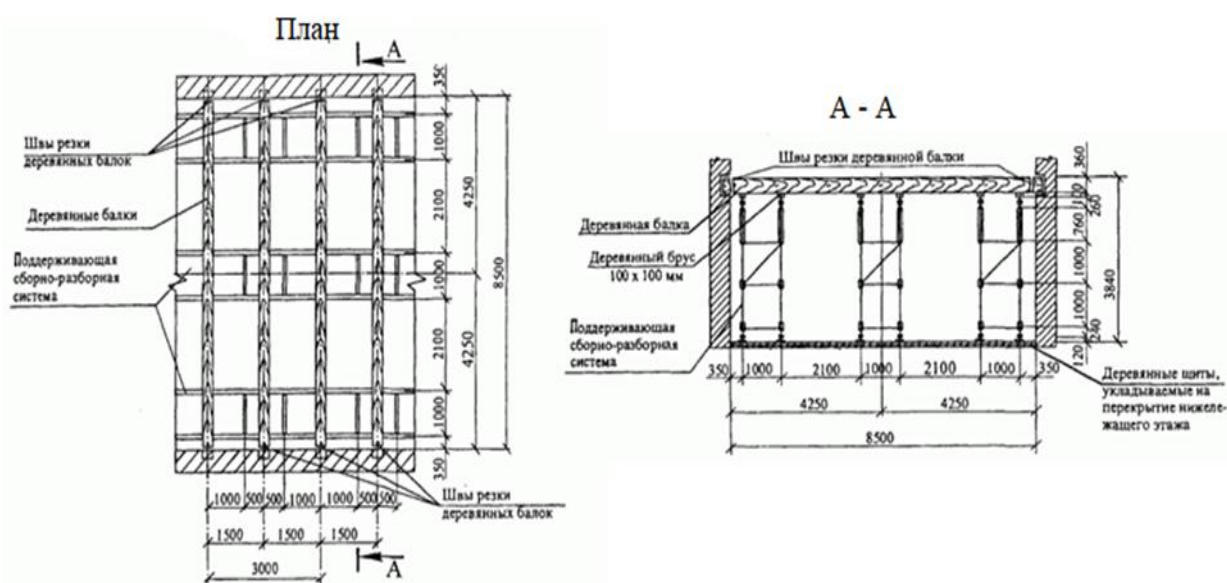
Схема разборки перекрытия по деревянным балкам
